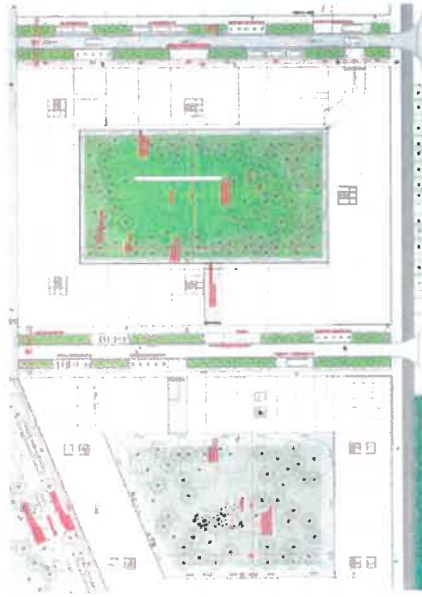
Principes d'aménagements des îlots. Plan guide de la bande centrale, Juillet 2015.
